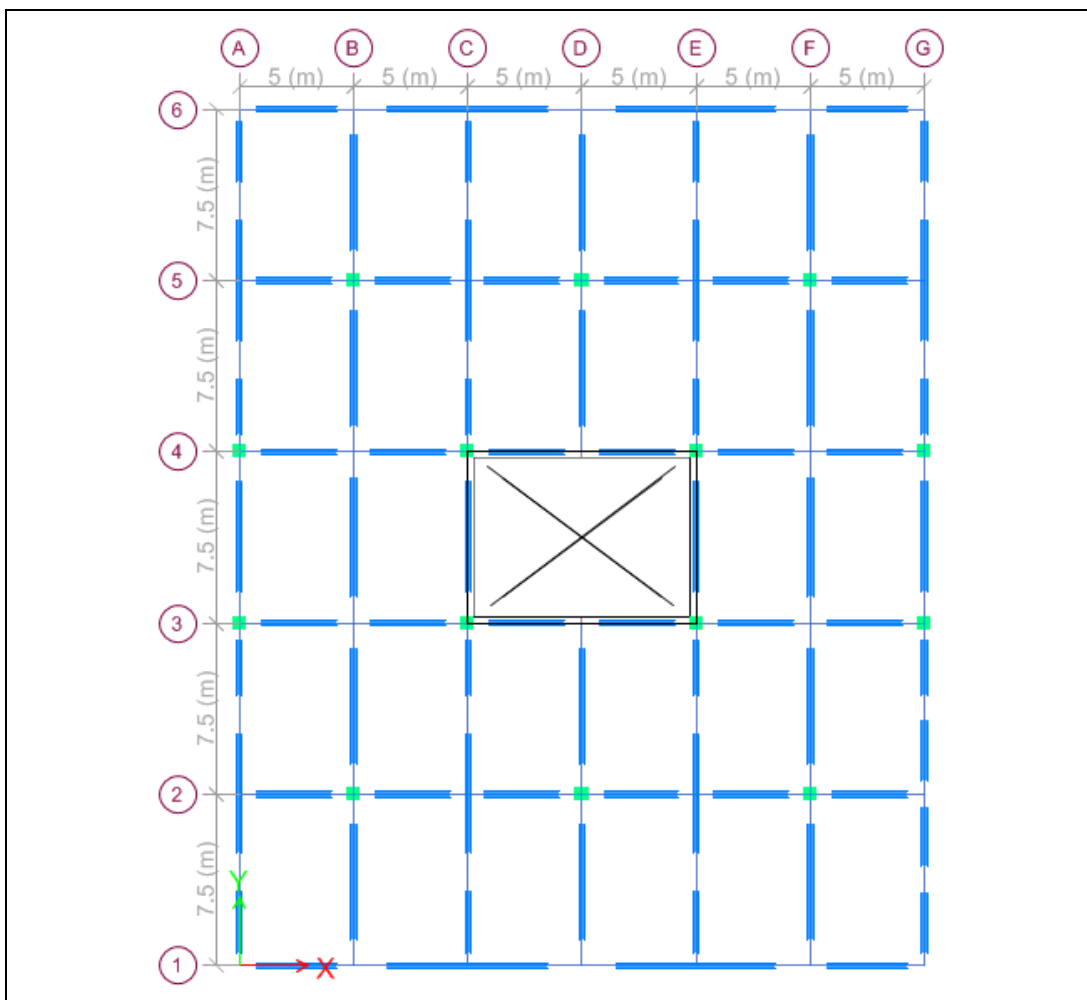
Estructuración Planta Típica del Sistema Diagrid Modelo B.
